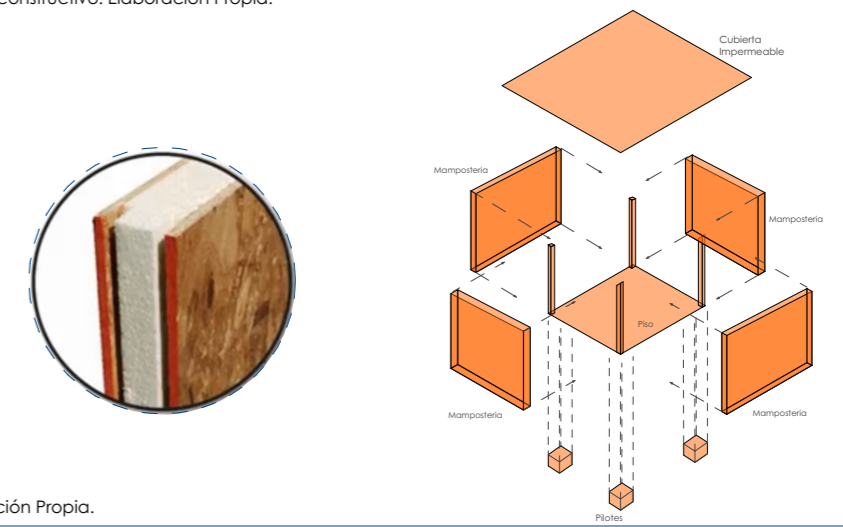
Sistema Constructivo y materiales. Elaboración Propia.
